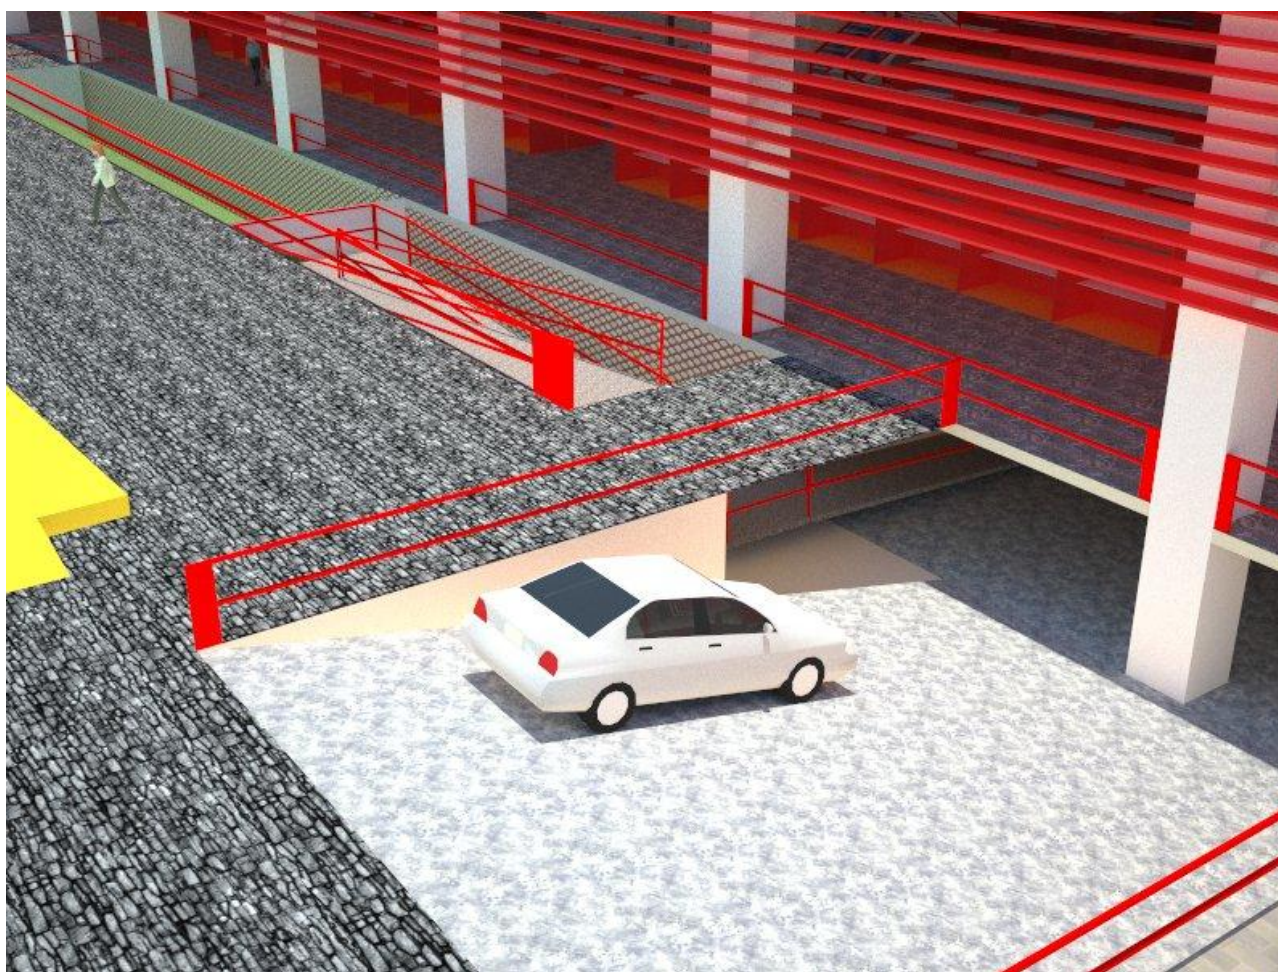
Vista externa da rua Dr. Pergentino Maia da entrada e saída para o subsolo.
